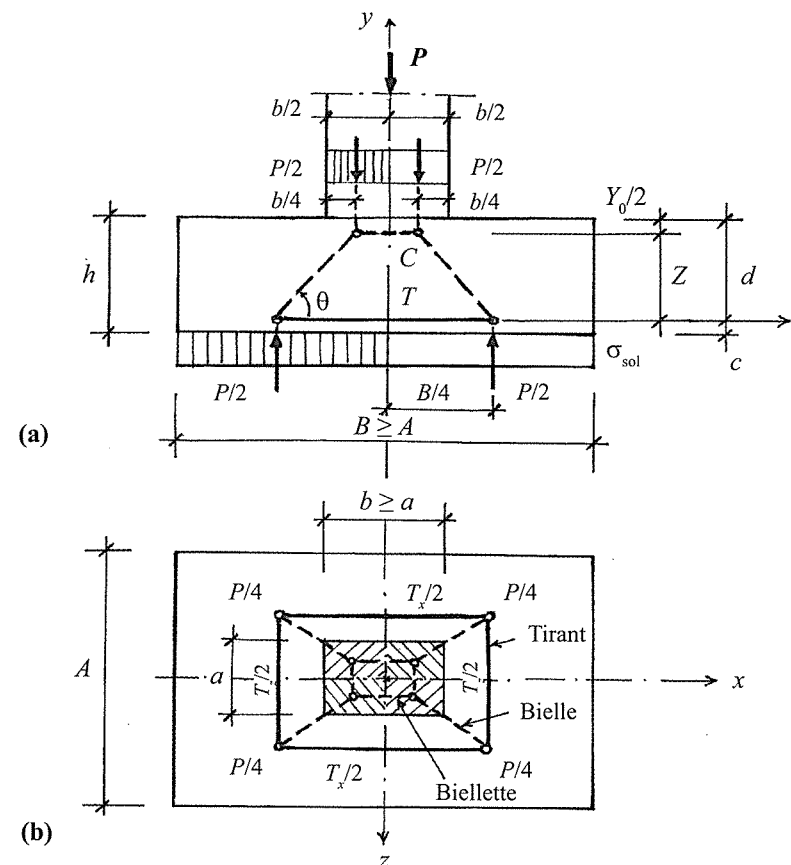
Modélisation B-T pour une semelle rigide sous mur (a) ou sous poteau (a et b) en compression centrée :
